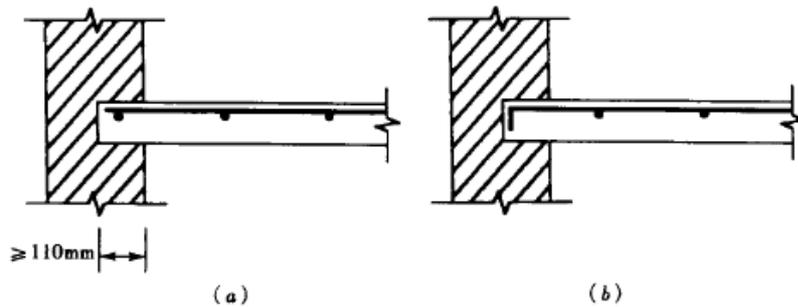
板上部受力钢筋焊接网的锚固
